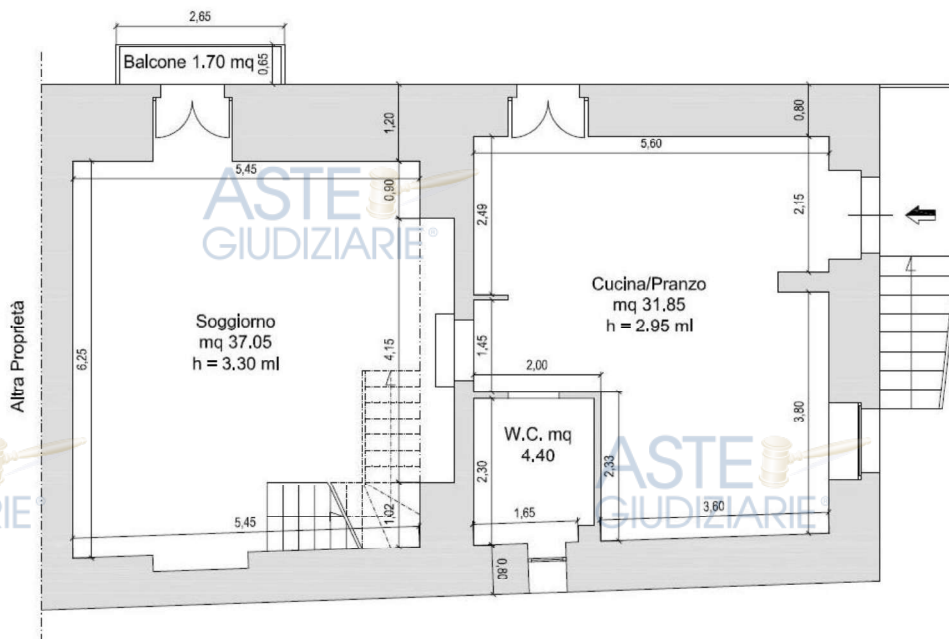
Planimetria Stato di Fatto Piano Terra, Foglio 20, p.lla 161, Sub 4.
